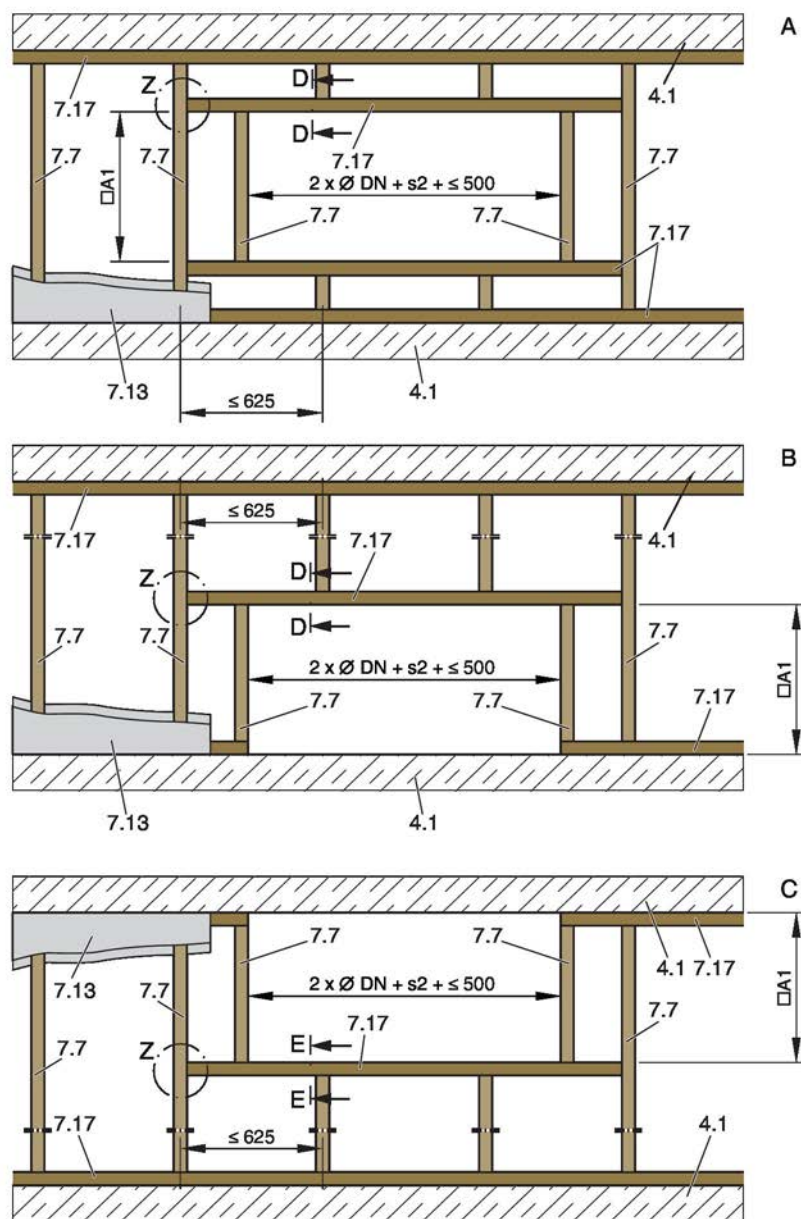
Perete despărțitor ușor cu structură de susținere din lemn și placare pe ambele părți, flanșă la flanșă, dimensiunile nominale: Ø lățimea nominală 315 – 400, legendă Fig. 51
